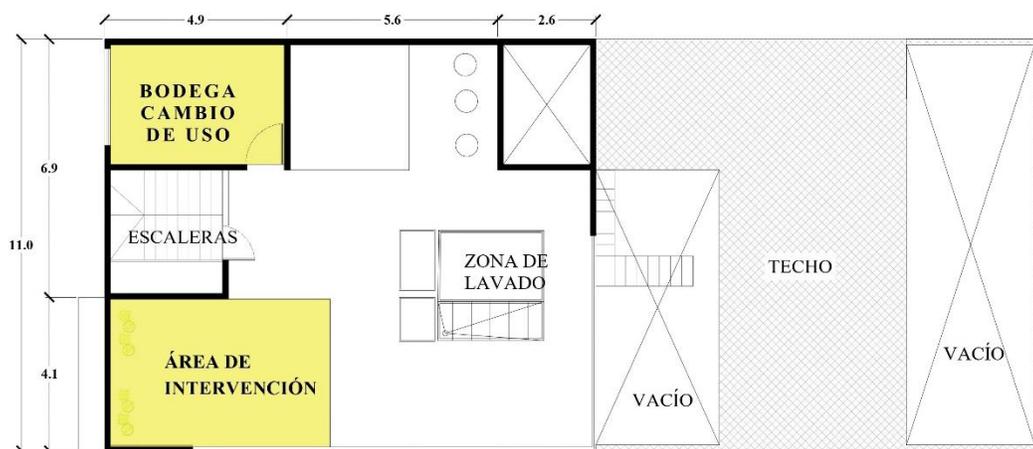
Planta arquitectónica de la distribución actual del caso de estudio uno.
